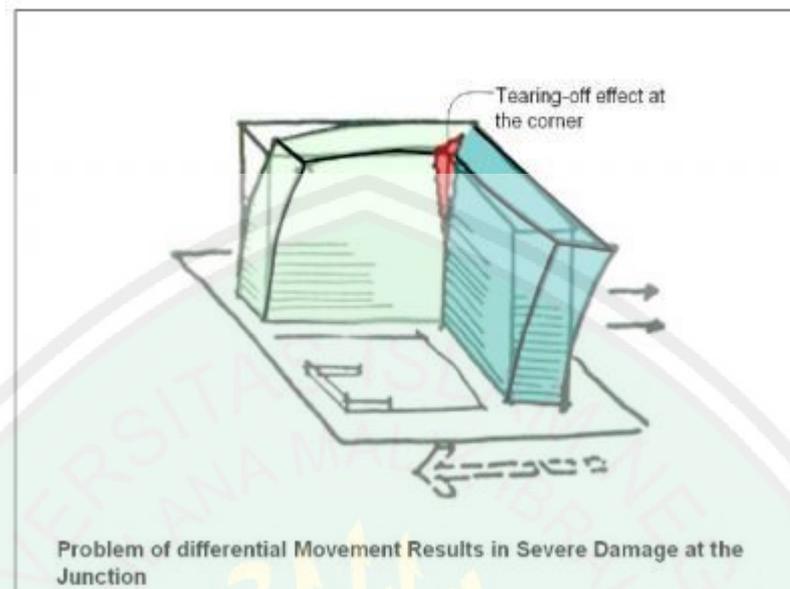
Pemisahan bangunan ini hanya terjadi pada bagian struktur bangunan
